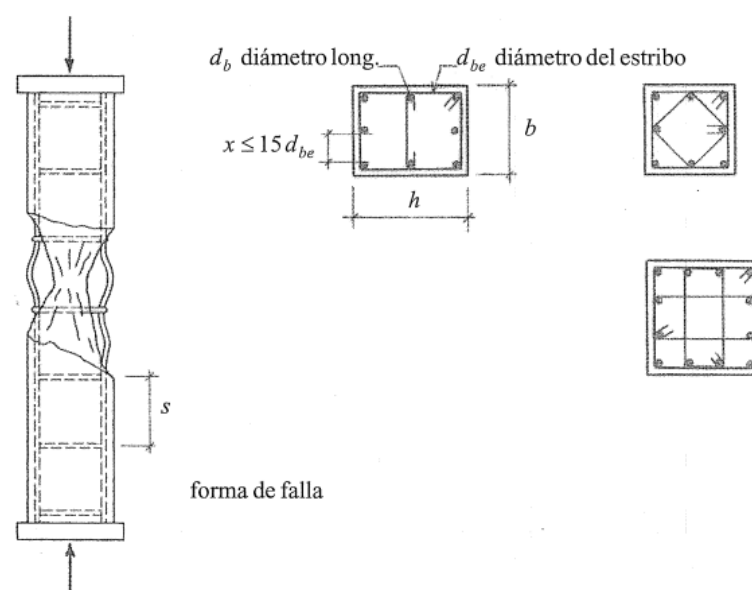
Columna con estribos. (Fuente: Moller, 2010)
